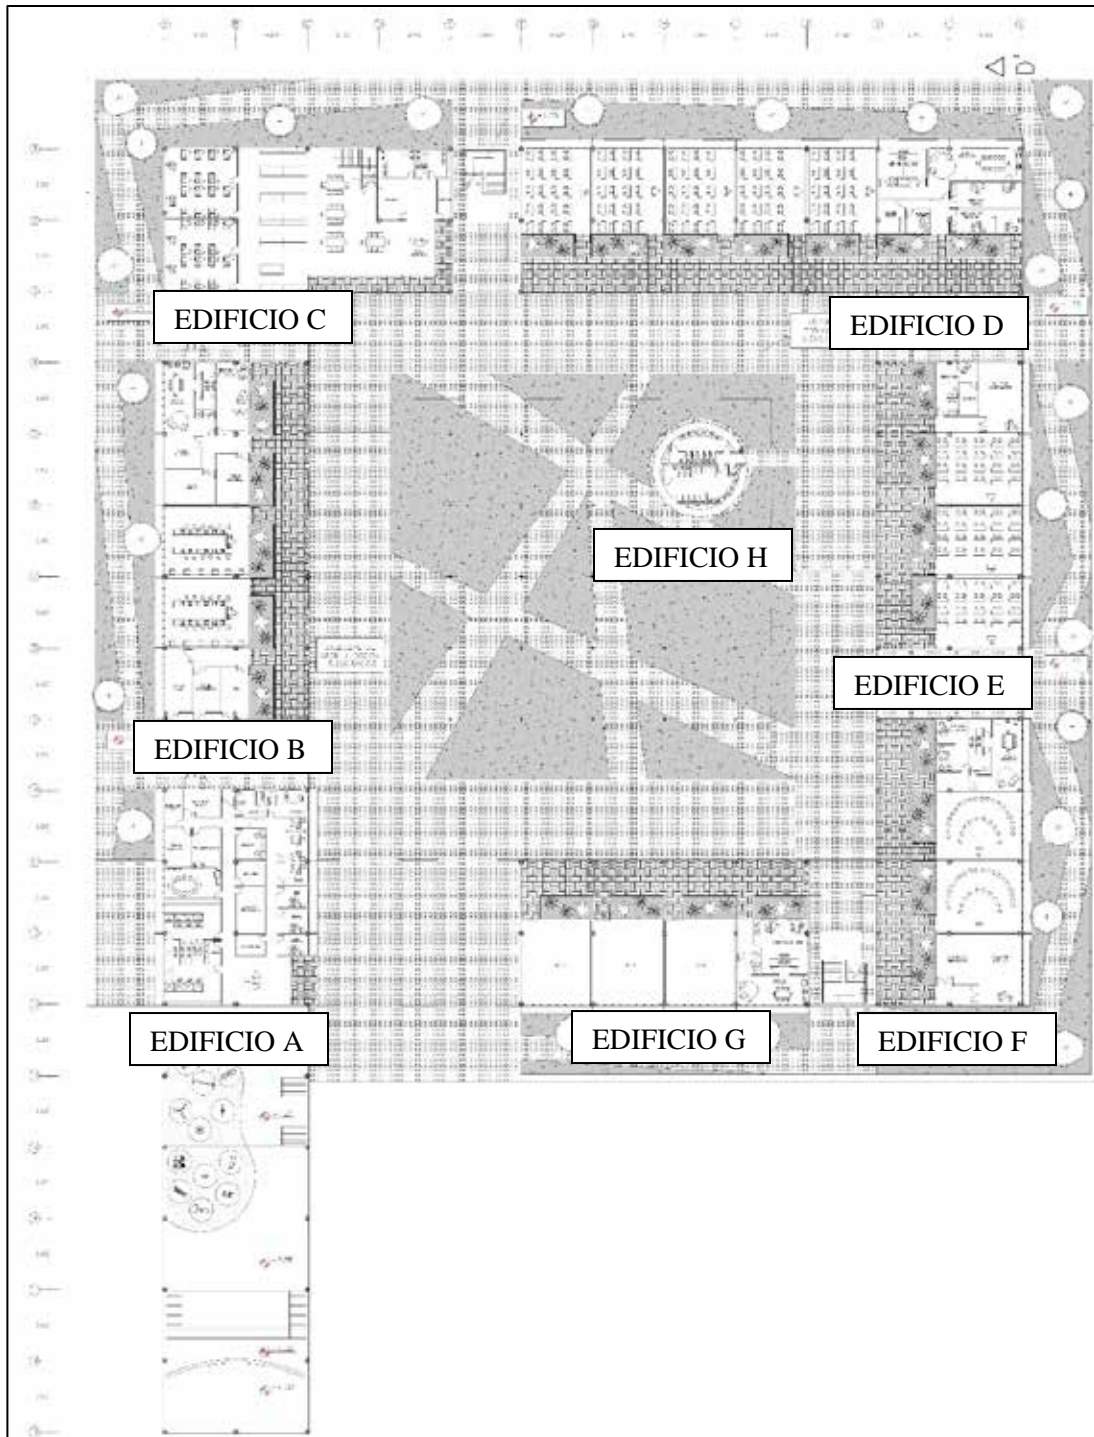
Planta Baja complejo. Nombres asignados a cada módulo para su explicación. Fuente: Propia autoría. (2018)
